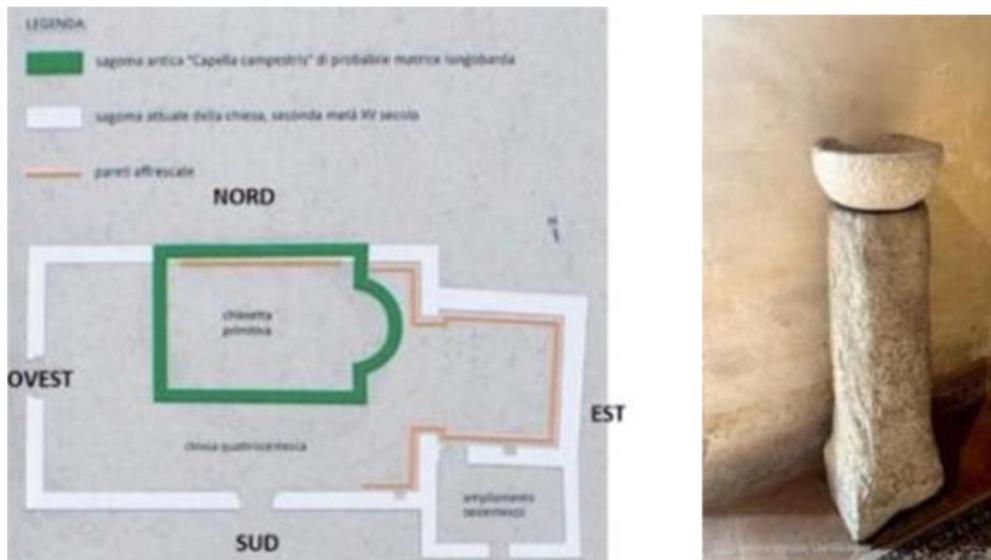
Planimetria della chiesa della Santissima Trinità a Cappella Maggiore (TV) e dell'acquasantiera di epoca longobarda (foto dell'autore)
